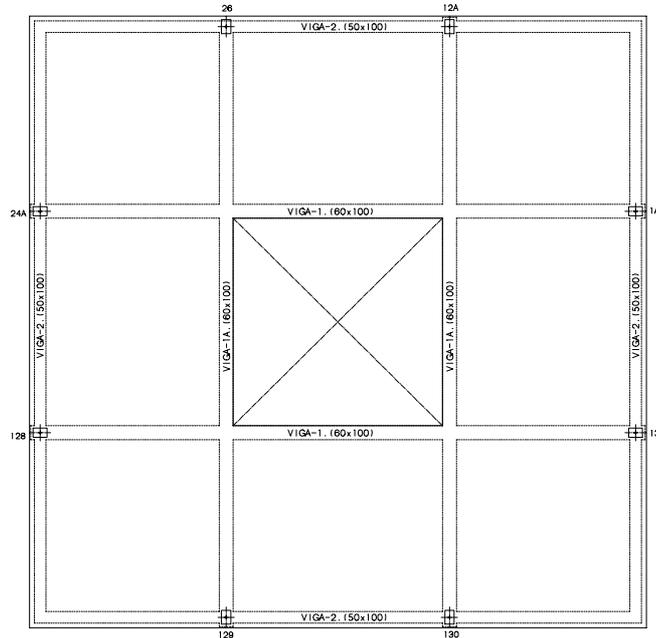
Planta de los edificios anexos. Solución estructural adoptada.
